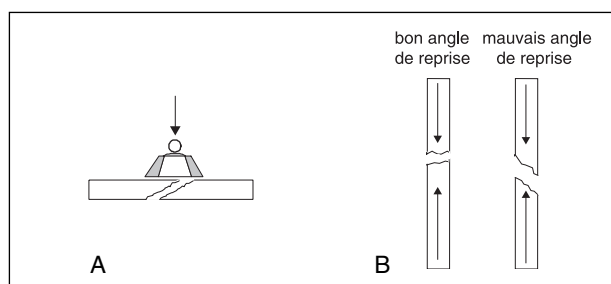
Reprise de bétonnage. A, reprise pour un plancher. B, reprise pour un mur soumis à une charge verticale.
